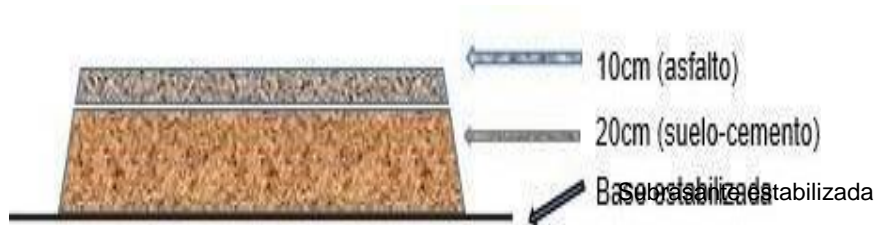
Diseño estructural de pavimento flexible base suelo-cemento
